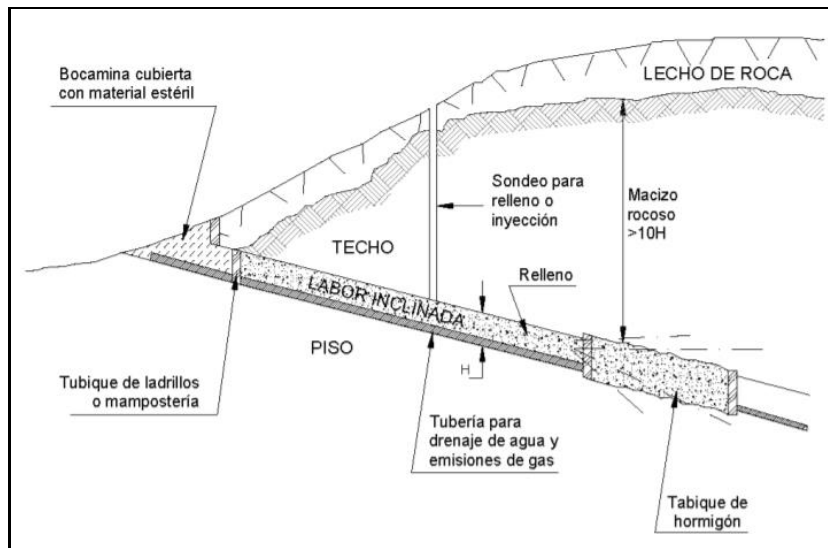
Ubicación del tapón de hormigón en un túnel inclinado.
